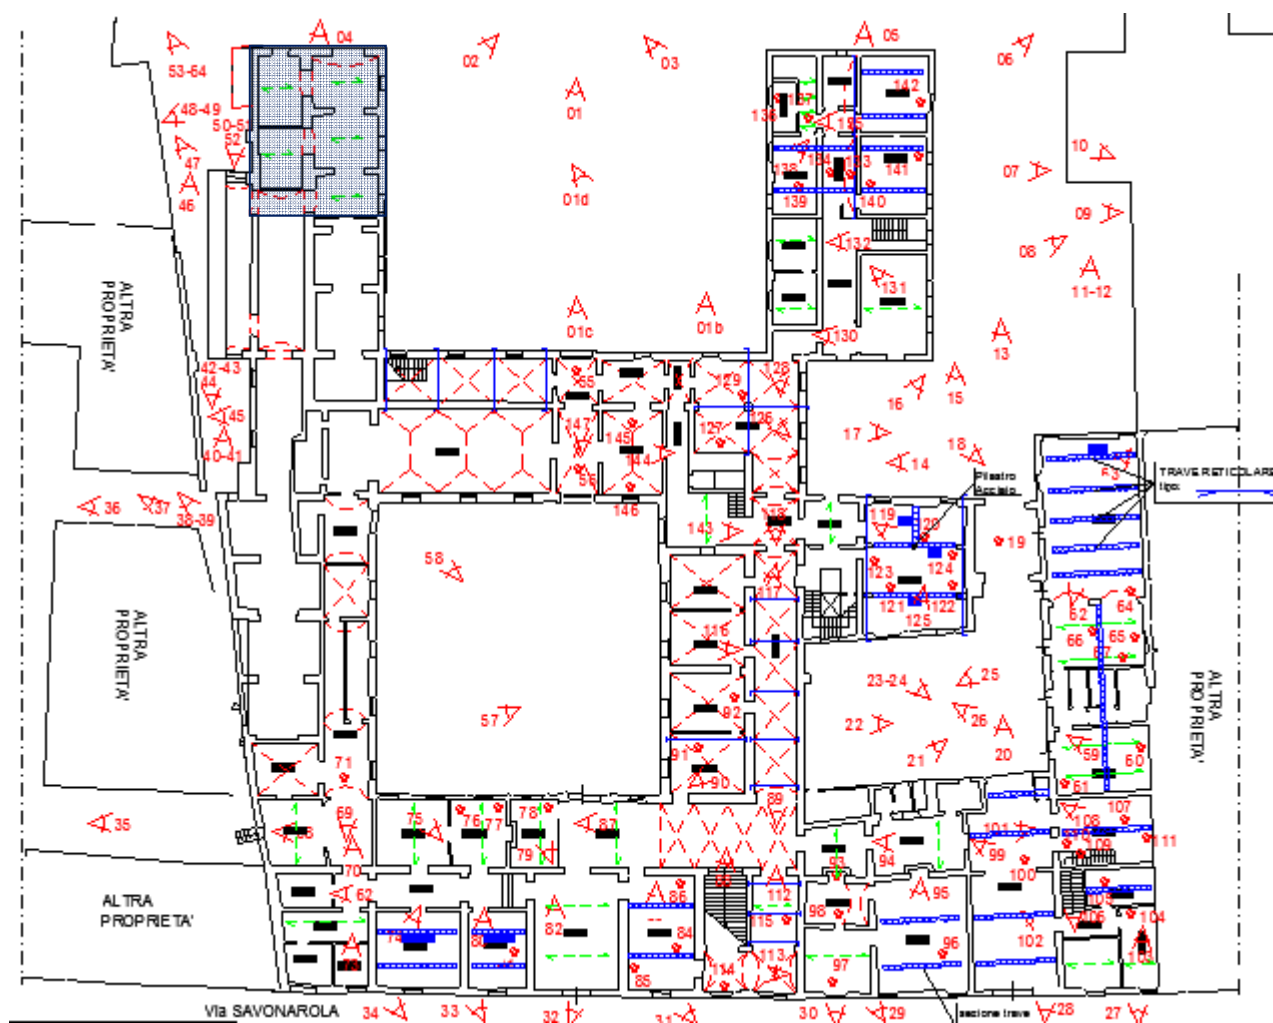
Pianta piano terra: orizzontamenti e strutture voltate di piano primo
